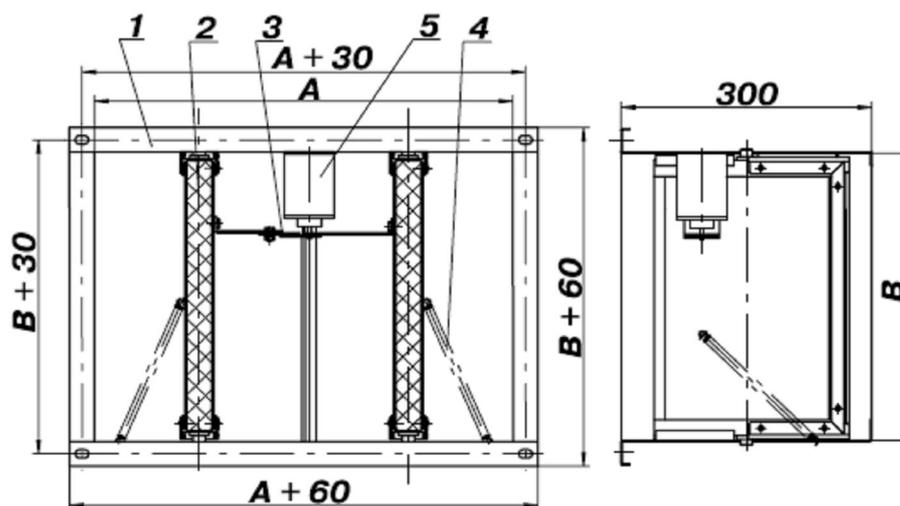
Прямоугольный клапан стенового исполнения с электромагнитным приводом, установленным внутри: 1 – корпус; 2 – лопатка; 3 – плавкий предохранитель; 4 – пружина; 5 – электромагнит
